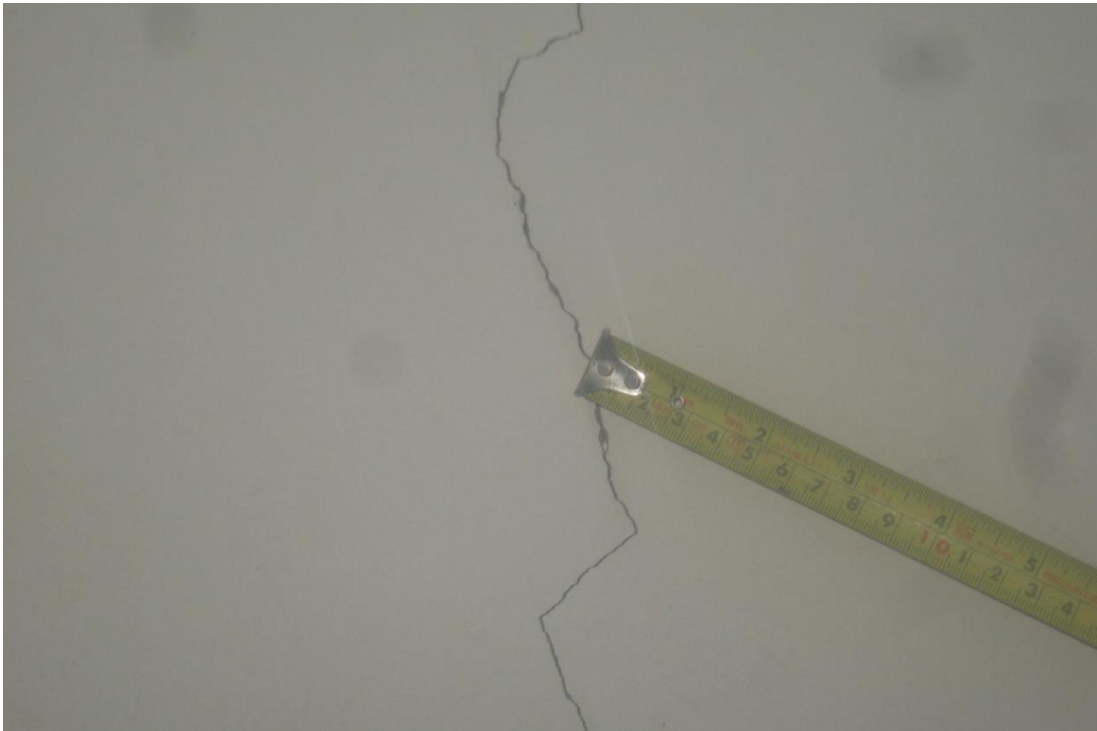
FISURA EN VIGUETAS - CIELOS RASOS DE VIVIENDA
